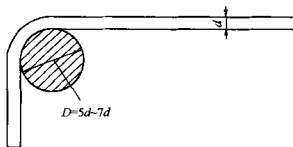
II 级钢筋弯转 90° 示意图
